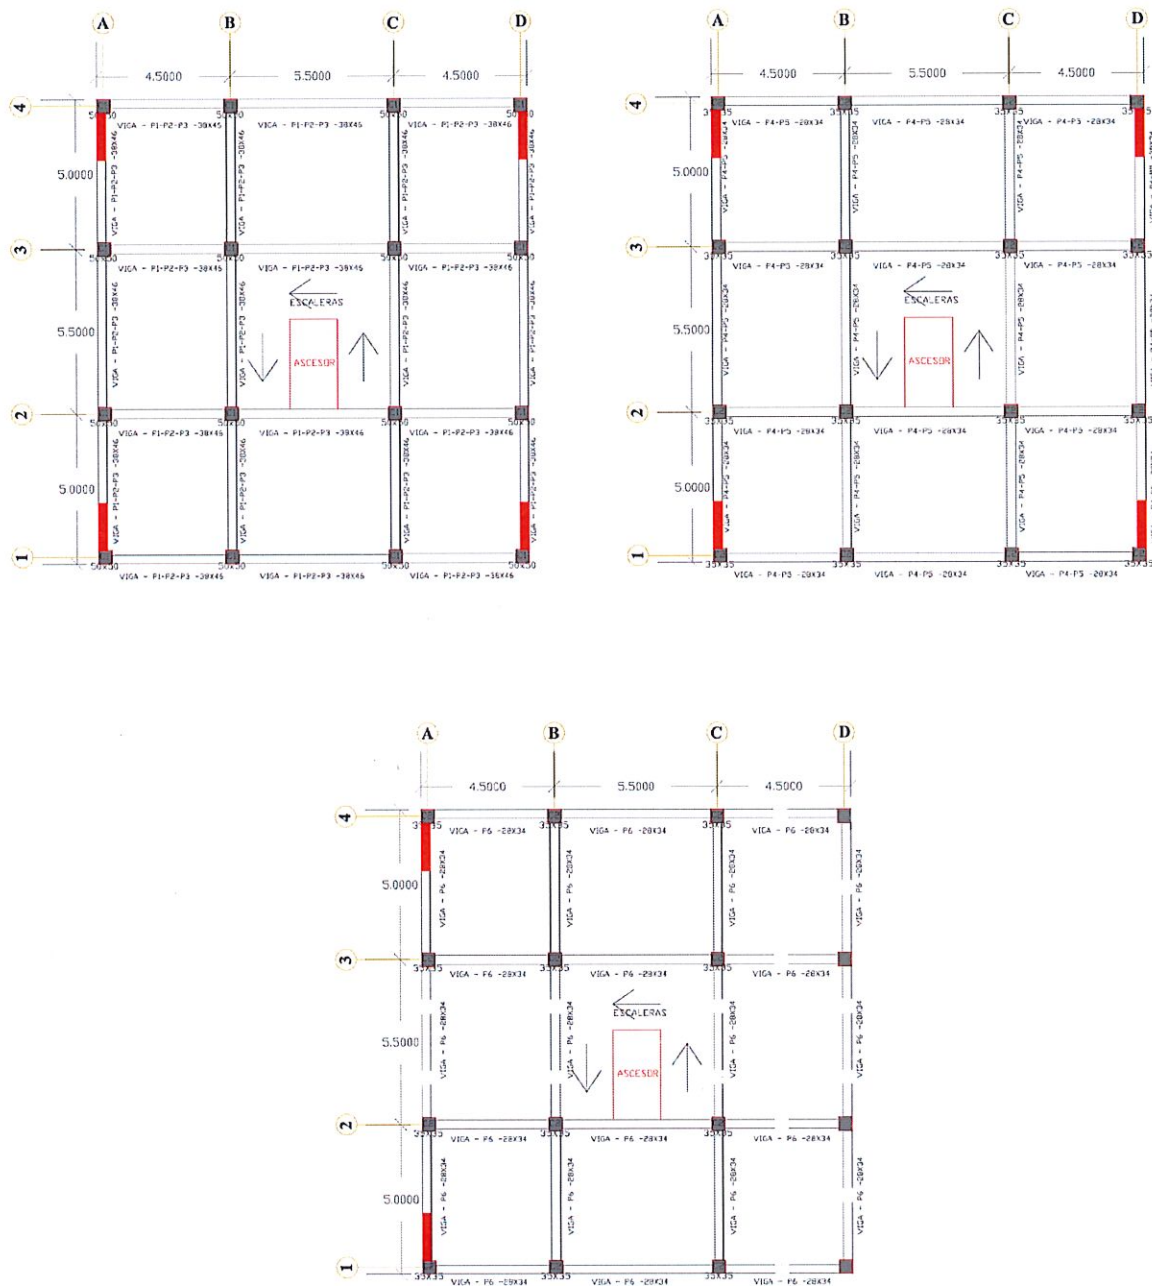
Planos de planta 1-6 piso del modelo estructural de hormigón armado con muros estructurales.
